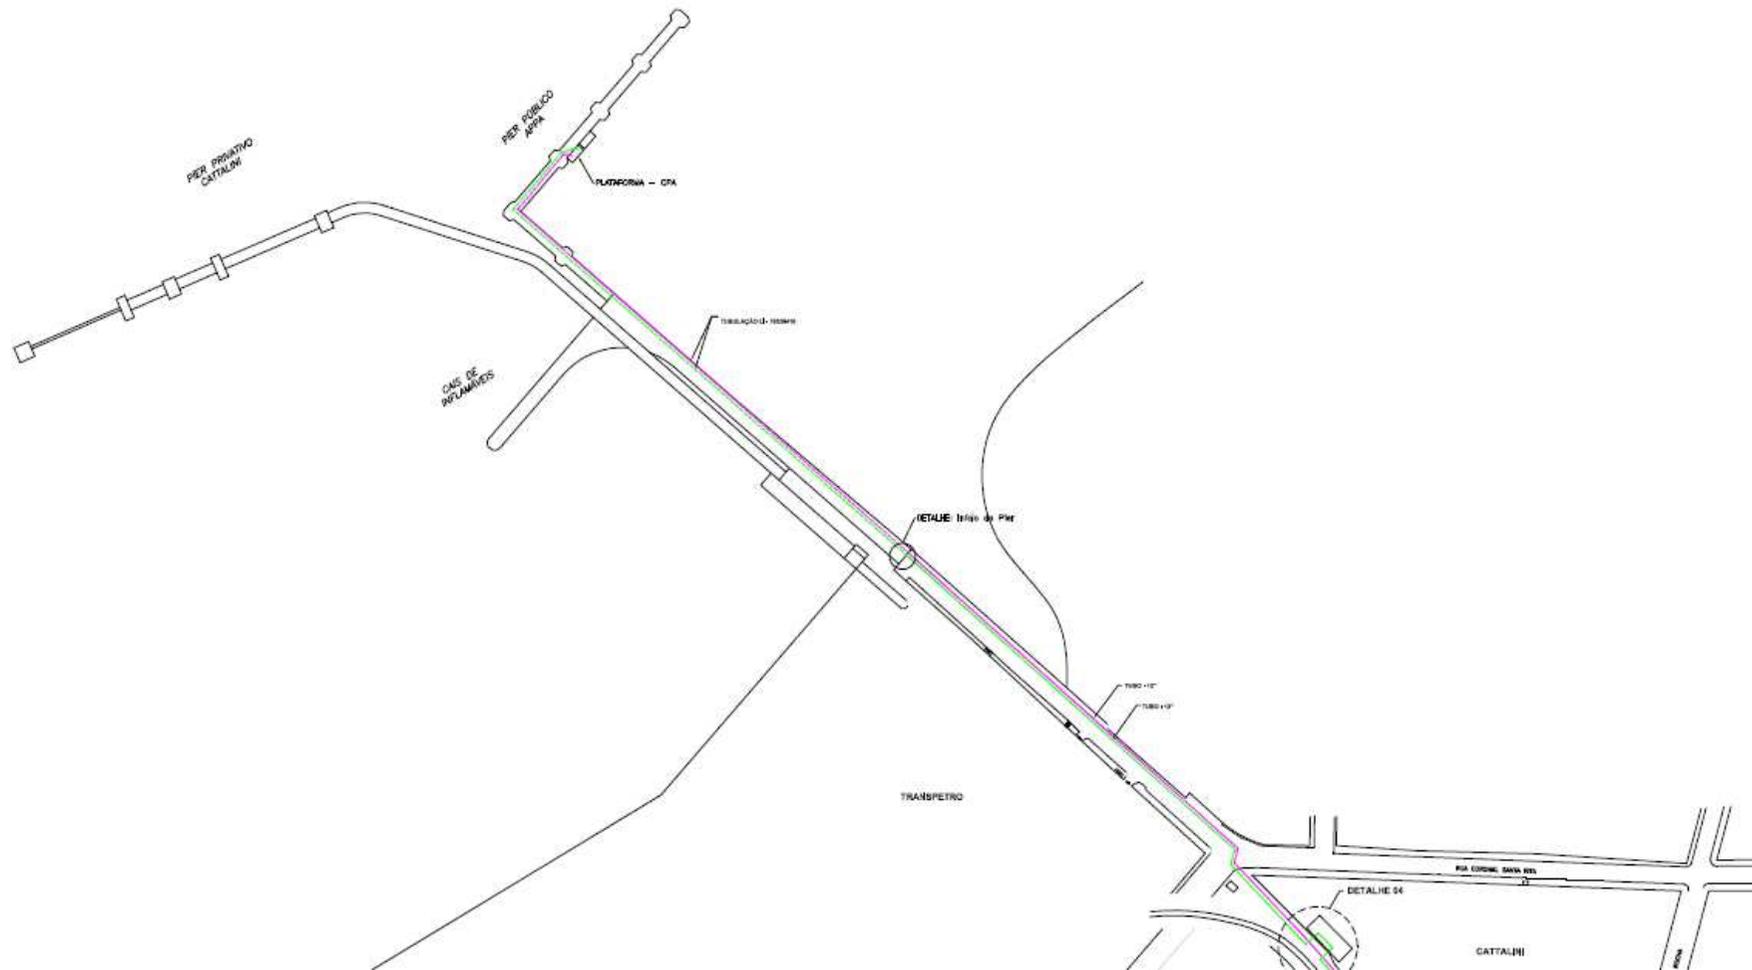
Traçado do duto entre a CPA Armazéns Gerais e o Pier (2)
